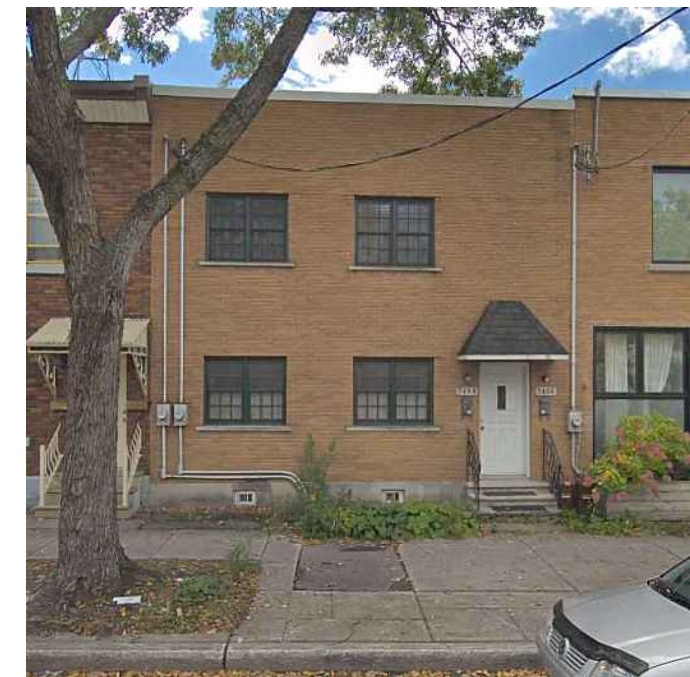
PHOTOS DE L'EXISTANT - FAÇADE AVANT ET VOISINAGE
